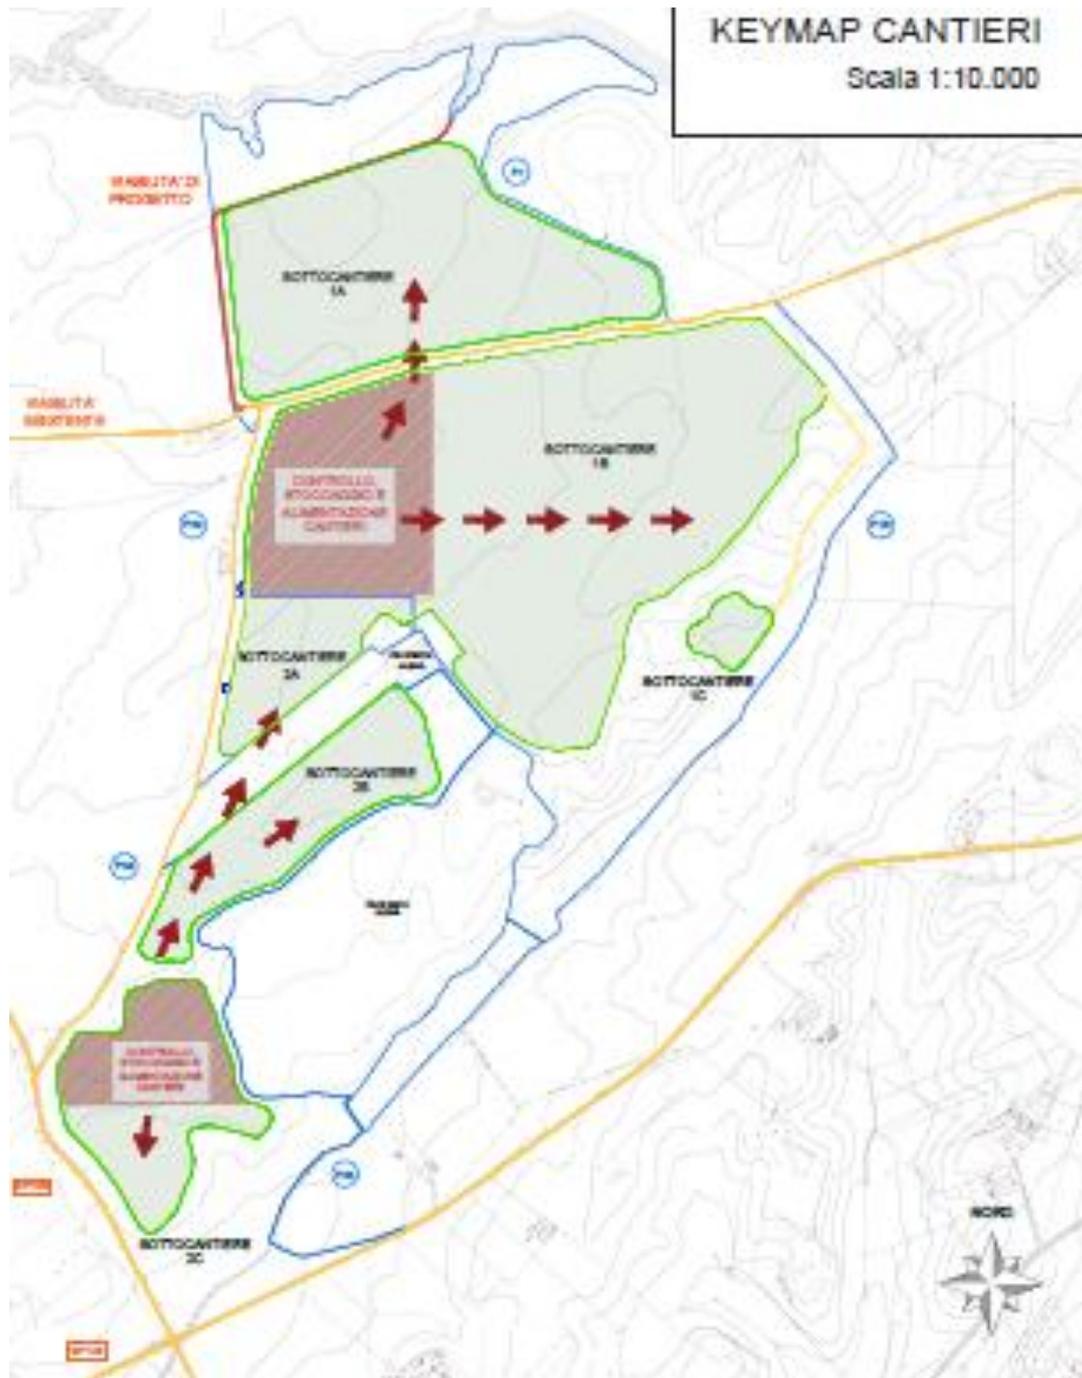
Schema generale di cantiere (fonte: 45\_PR\_10\_Piano di cantierizzazione)
